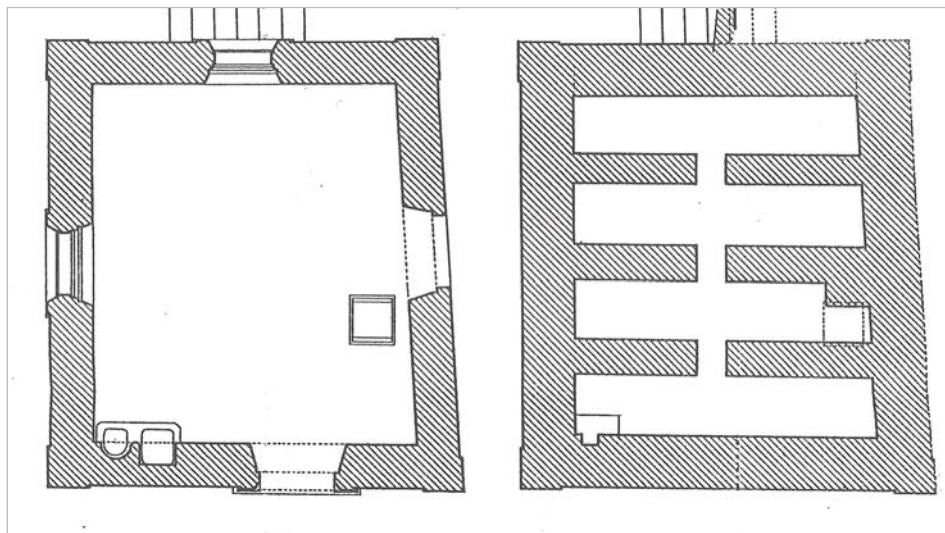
Planta y basamento del actual Pabellón de don Pío (F. Cebrián)
